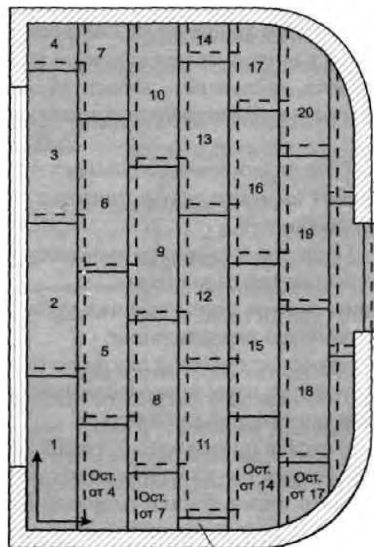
Укладка элементов пола от стены, противоположной стене с дверным проемом.
